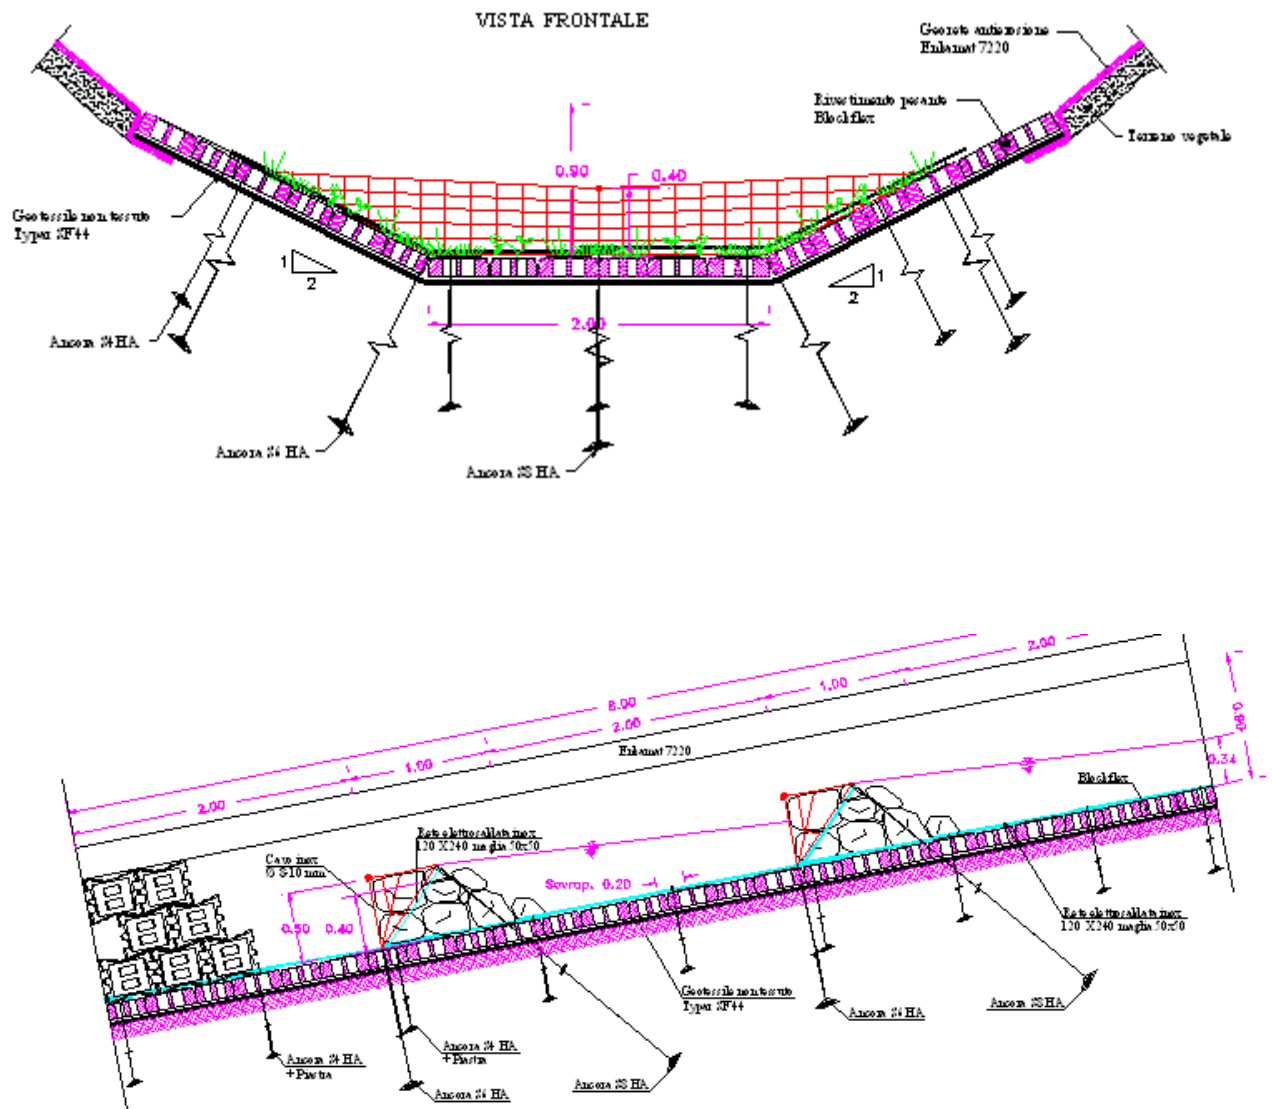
Sezione trasversale e longitudinale del canale di gronda
